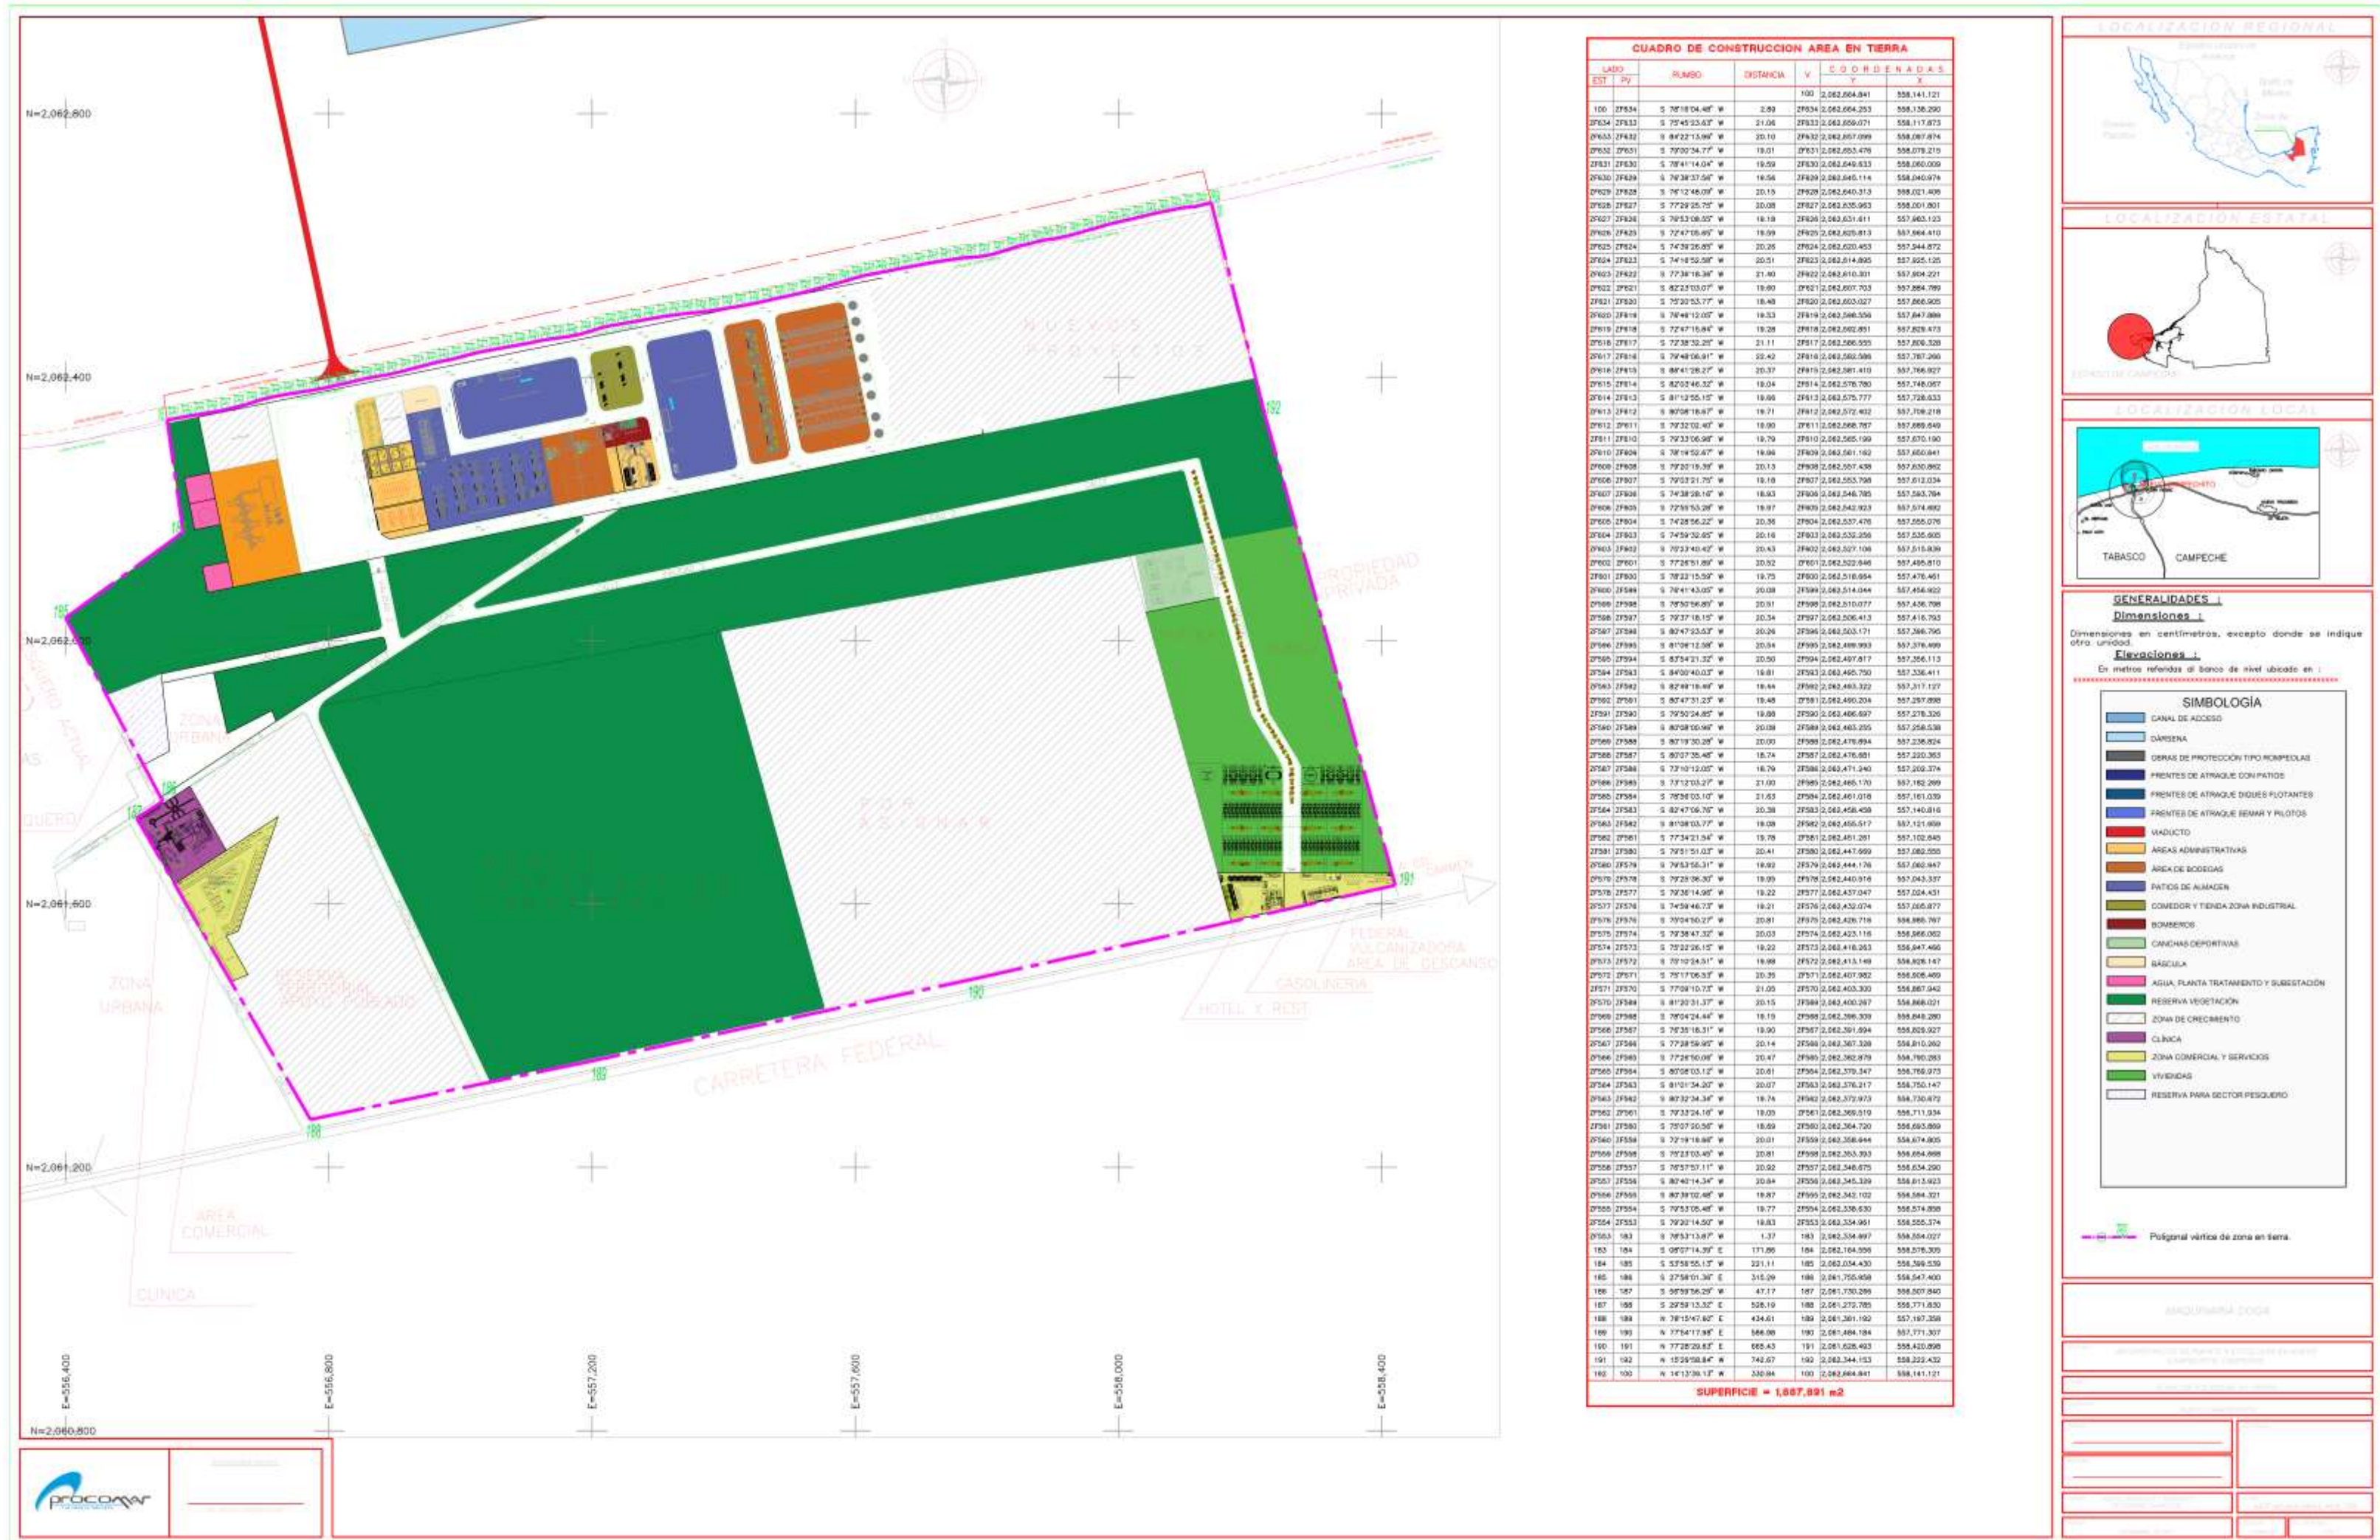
Cuadro de Construcción con Coordenadas de las Obras en Tierra
